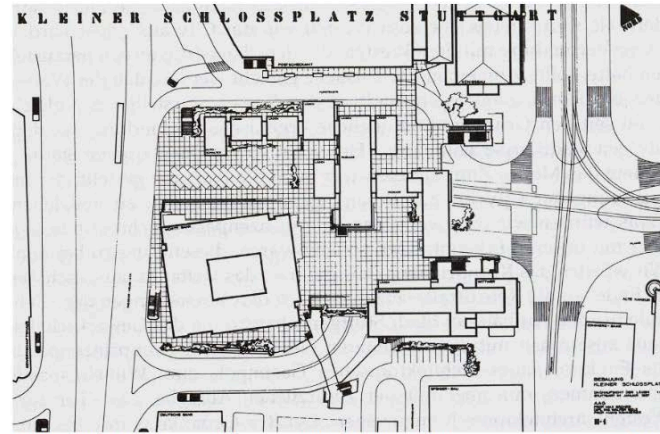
Stuttgart. Kleiner Schloßplatz. Bebauungsplan von Bächer und Kammerer / Belz, 1967.
